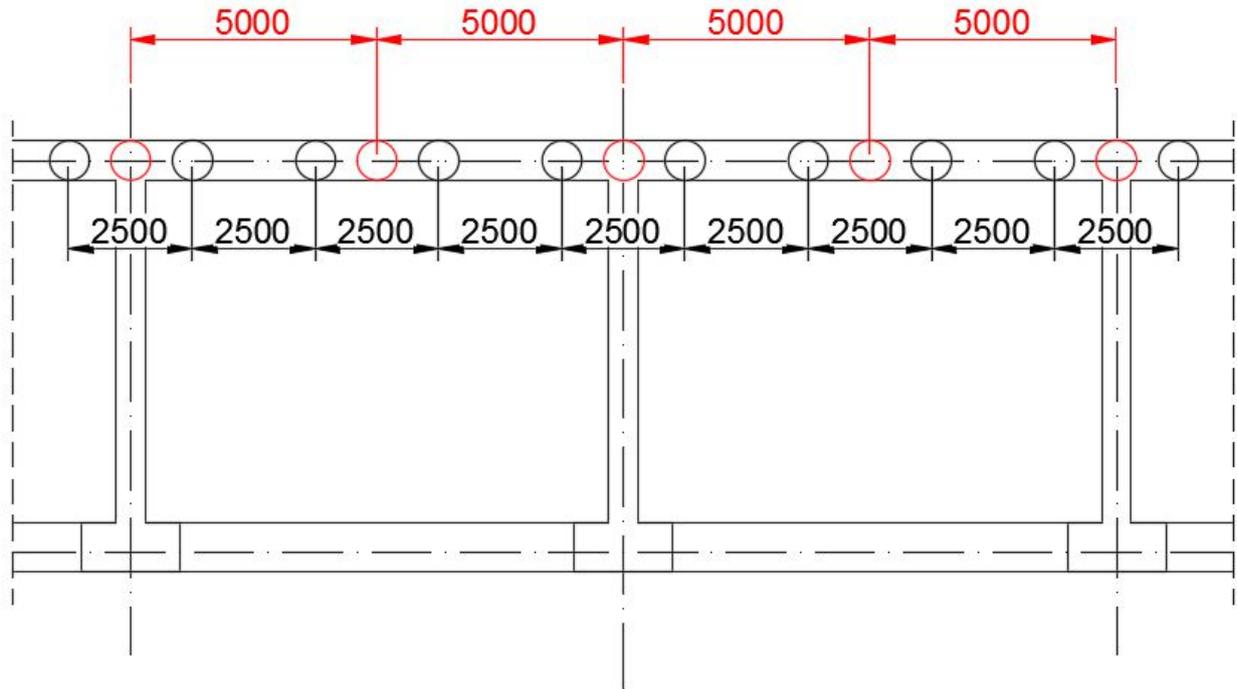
Banchina di riva – stralcio planimetrico delle fondazioni.
